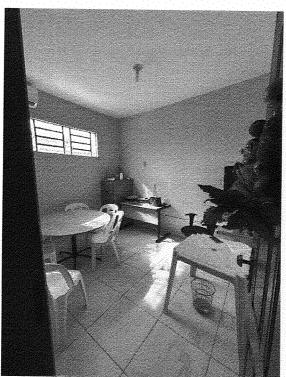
Sala 02 2° pavimento. Fonte: Autor.
